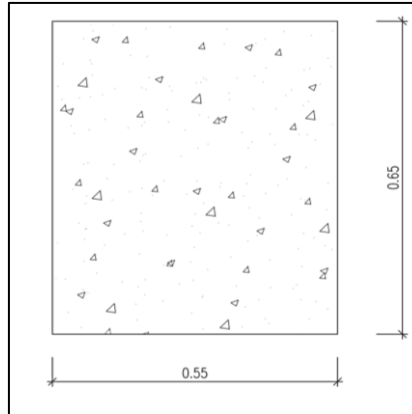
Sección transversal de la viga longitudinal. Fuente: Autor
